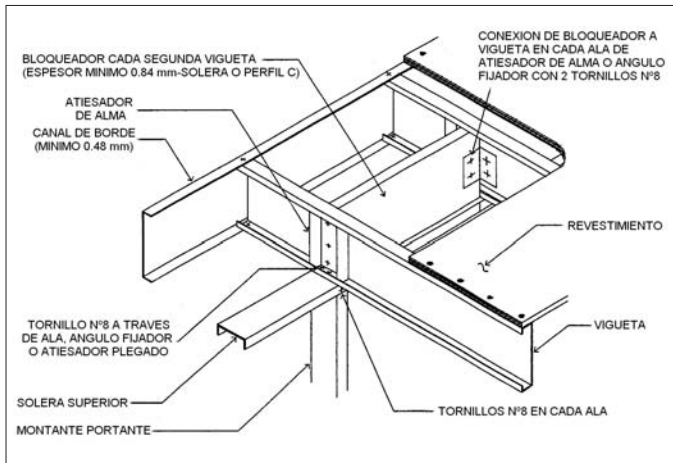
Piso en Voladizo Apoyado en Muro Portante Exterior
